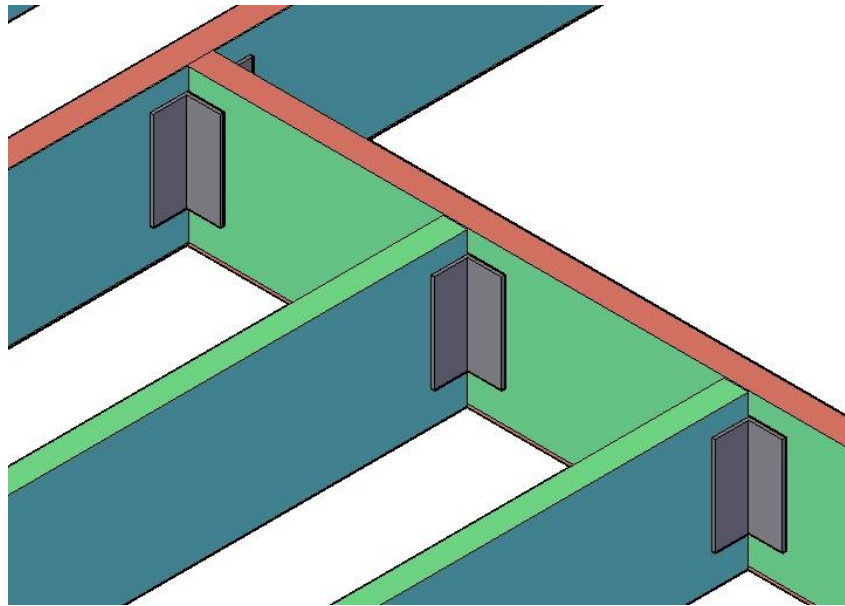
Emenda de viga de contorno (semelhante à emenda de canal, figura 6.8)
